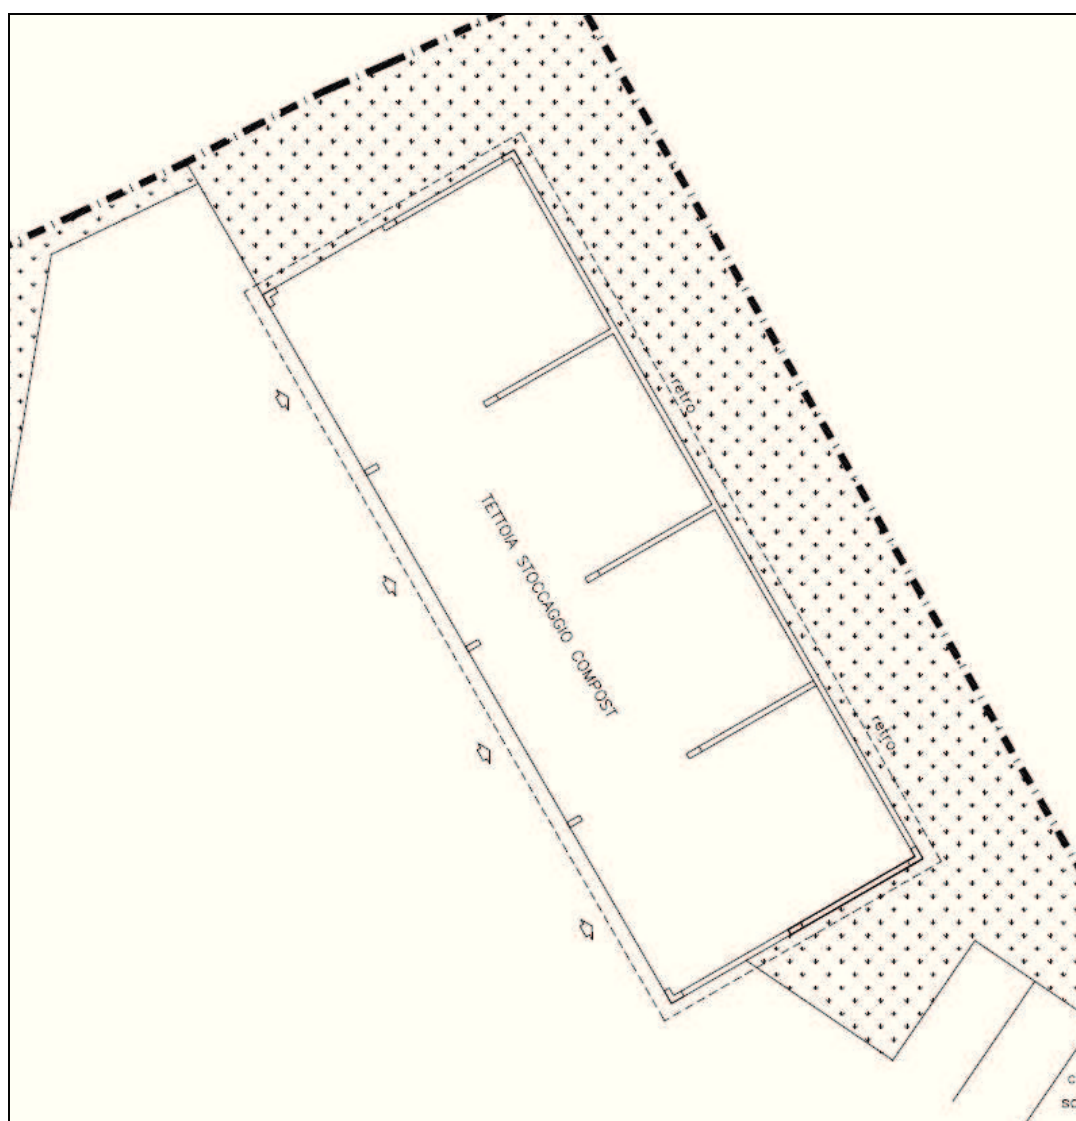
Stralcio planimetrico con ubicazione della tettoia per lo stoccaggio dell'ACM.
